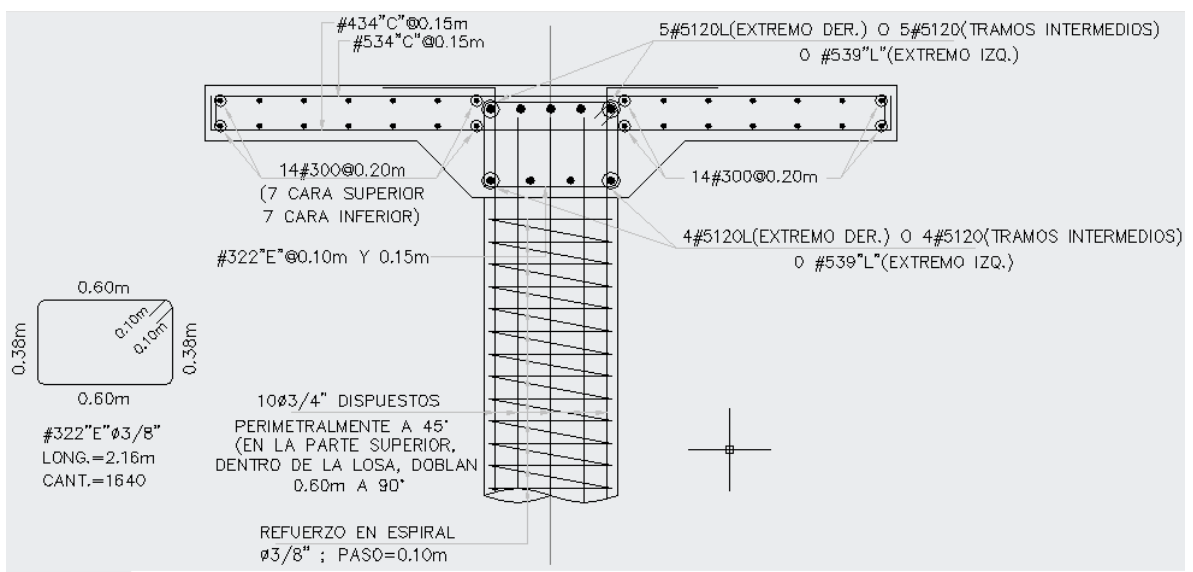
, Plano estructural Losa de cimentación y pilotes de concreto reforzado.
